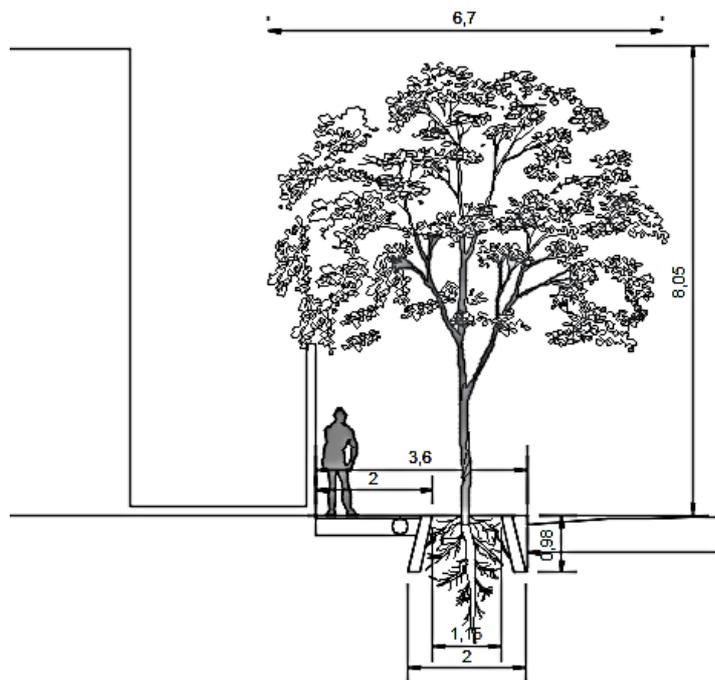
Propuesta de acera con una longitud de 3.6, con tazón reforzado de hormigón armado, pero aledaña a una construcción con retiro que le otorga un mayor espacio a la copa
